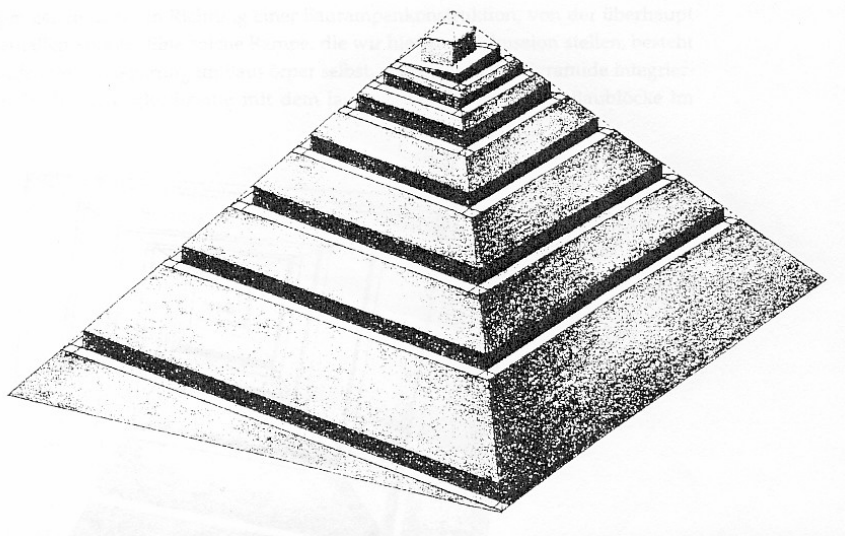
Rampenmodell nach Klemm und Klemm
